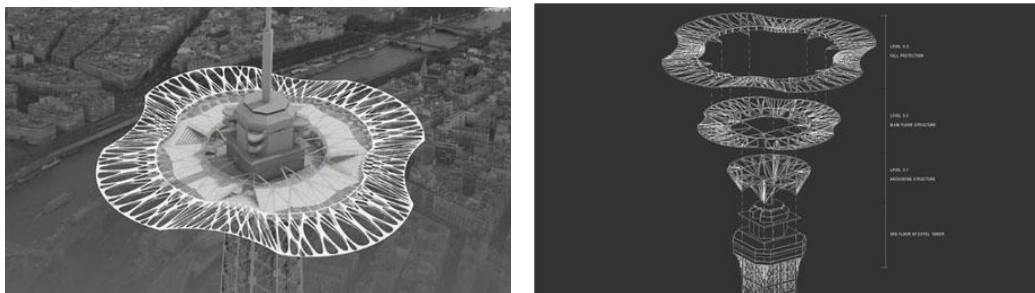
y 77. Alzado y planta de la plataforma de kevlar
